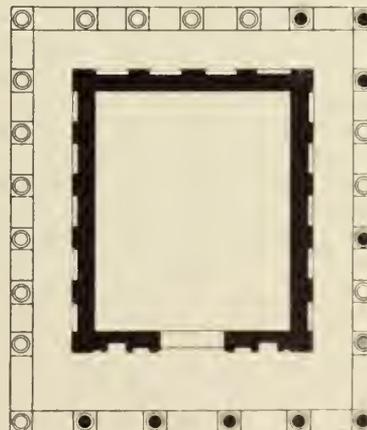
es-Suwêdâ: Tempel: Grundriß nach Butler 327.
